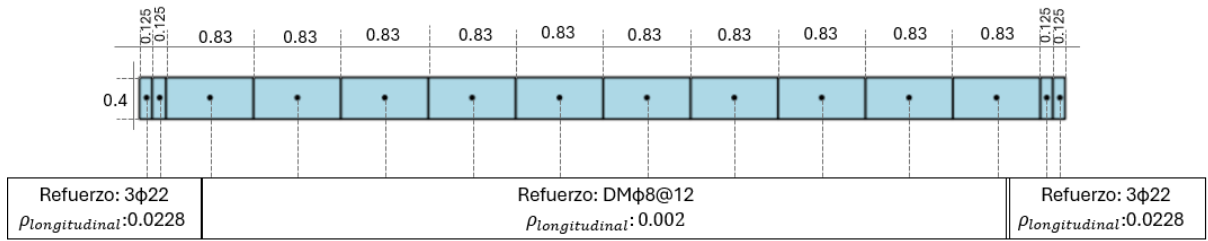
Esquema detallado de discretización de fibras de sección MC2.2. (ver Ilustración 25).
